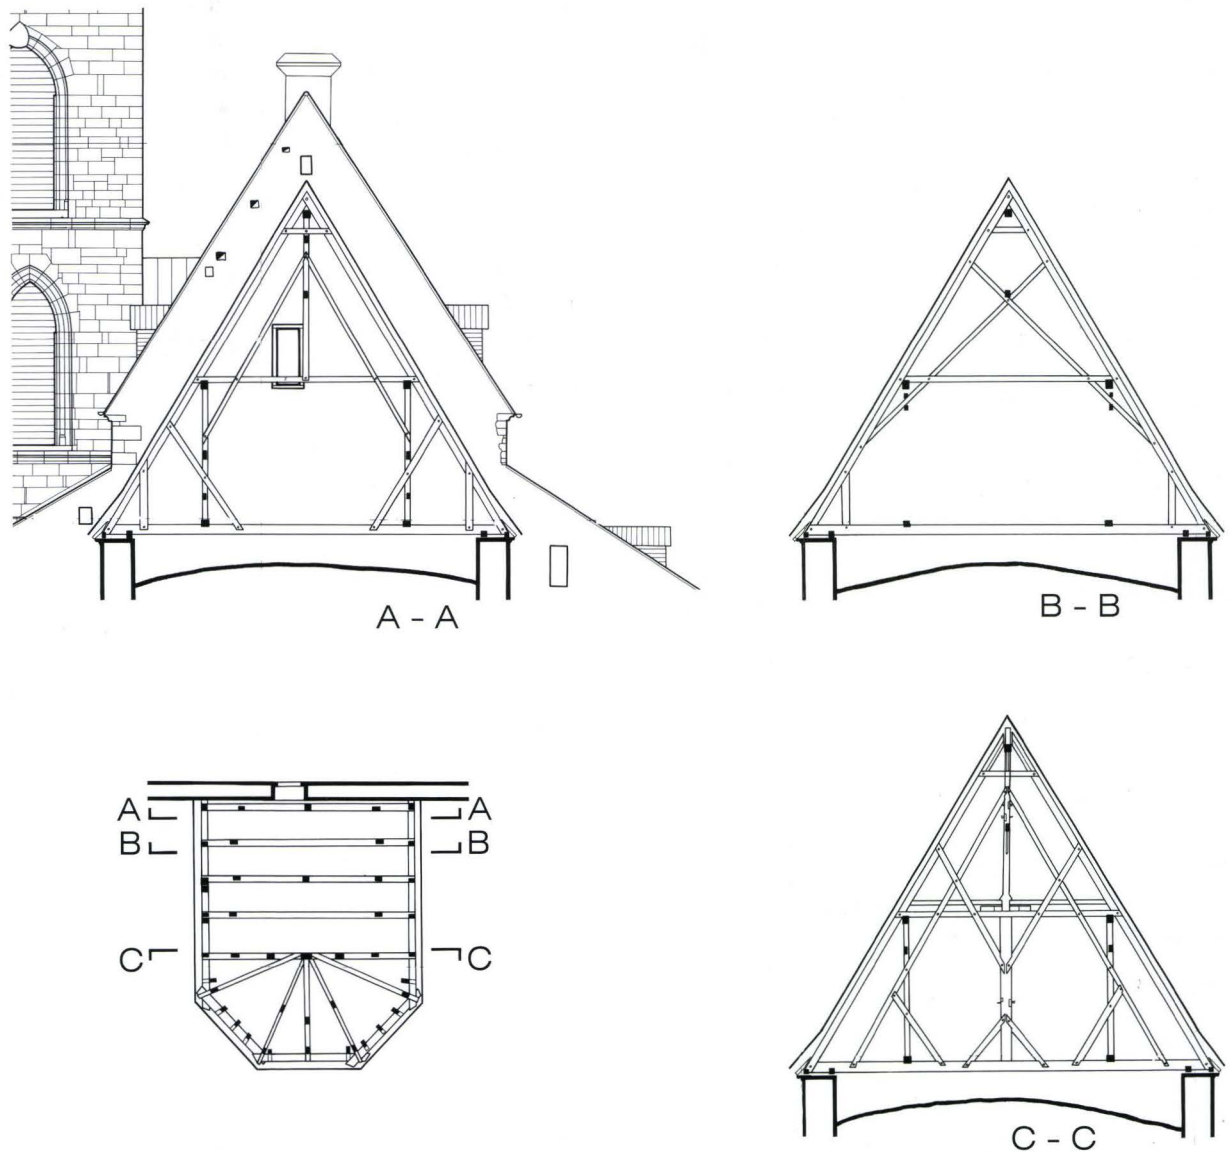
Martinskirche. Dach über dem Chor von 1398. Grundriss auf der Ebene der Kehlbalken und drei Schnitte. – Massstab 1:200.
